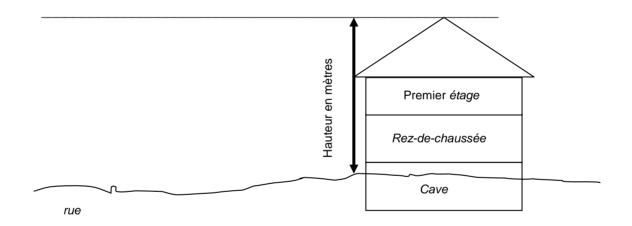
E Hauteur et niveaux d'un bâtiment
